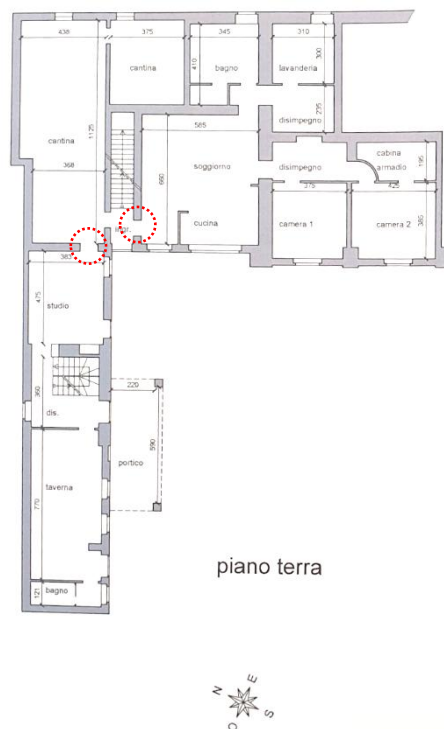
Stralcio della planimetria di progetto allegata alla CILA n. 09/2019 con evidenziate le due aperture non realizzate (cerchi con linea tratteggiata rossa)
